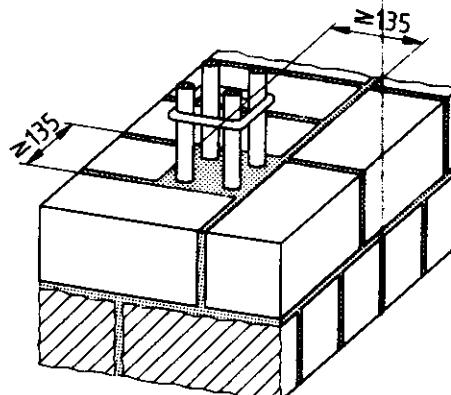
Bewehrung in ummauerten Aussparungen (Prinzipskizze)
